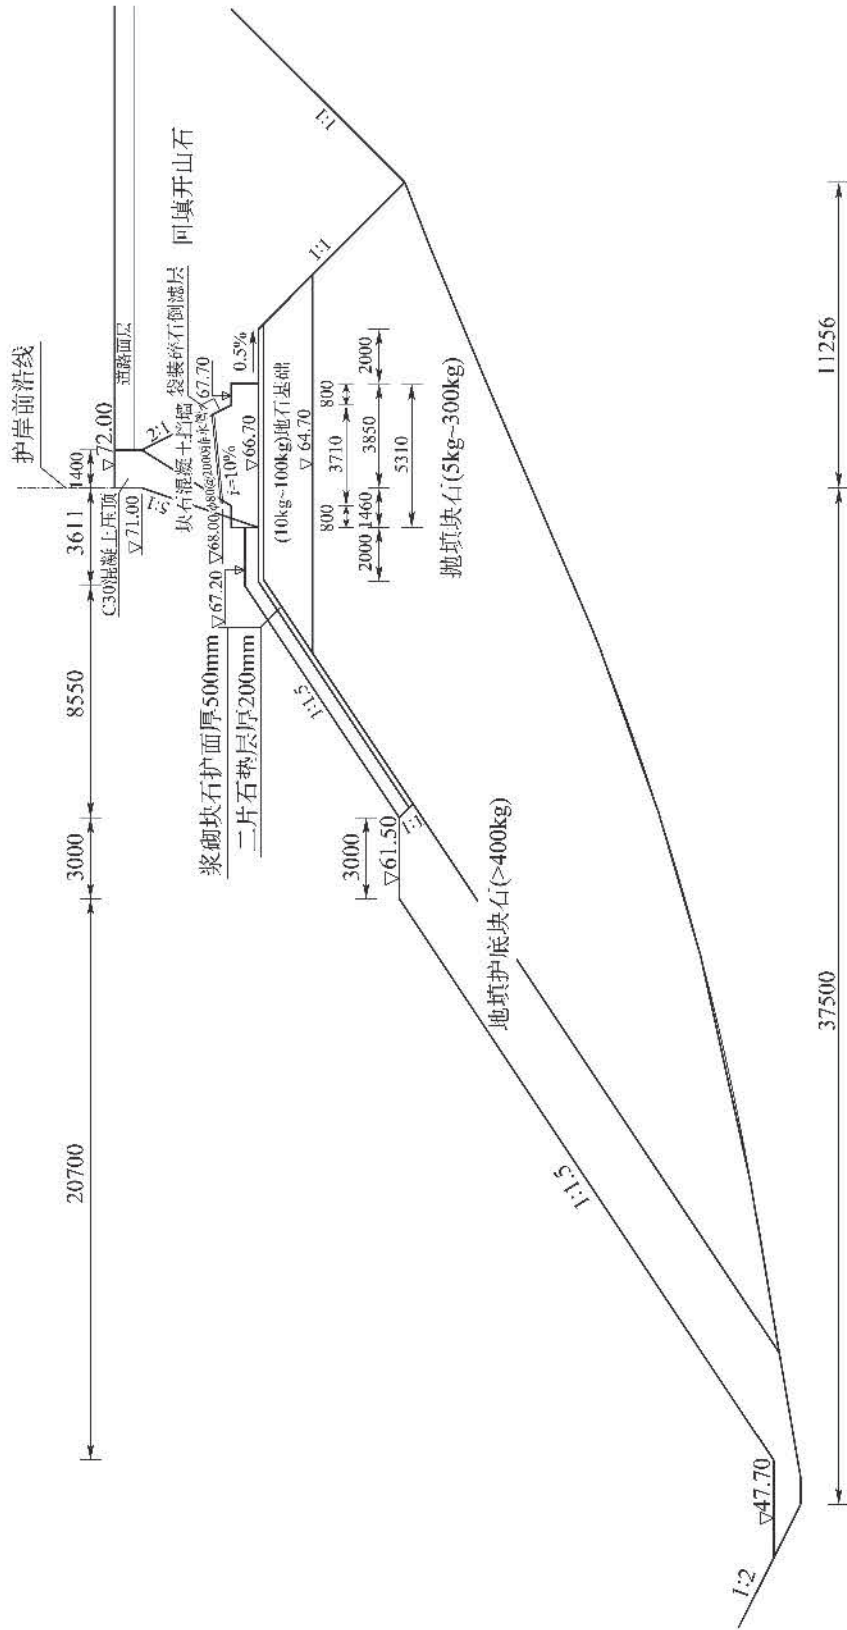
多用途码头-闽江某港口工程护岸断面示意图(尺寸单位:mm;高程单位:m)
